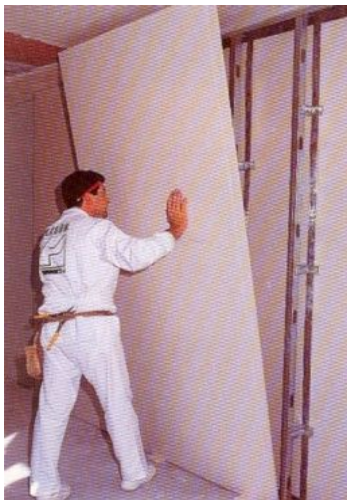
Colocación de yeso laminado sobre perfiles metálicos.
